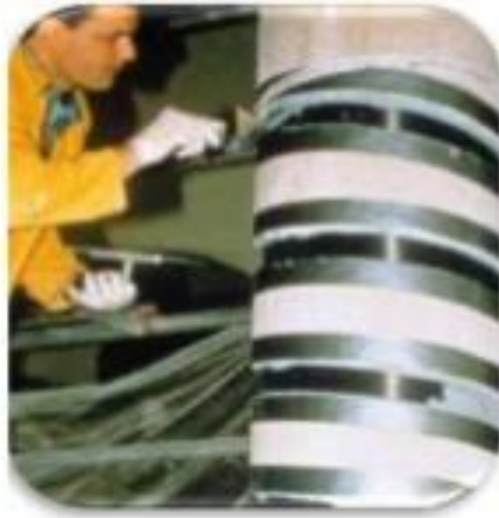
Mise en place de lamelles de carbone autour d'un poteau
